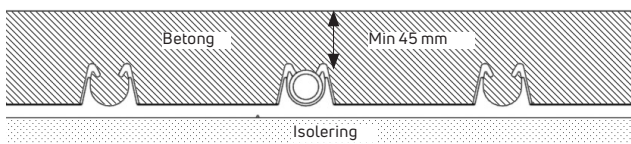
Monteringsdjupet, från rörhjässa till betongens överkant, bör vid förläggning med röravstånd c/c 300 mm vara minst 45 mm.
